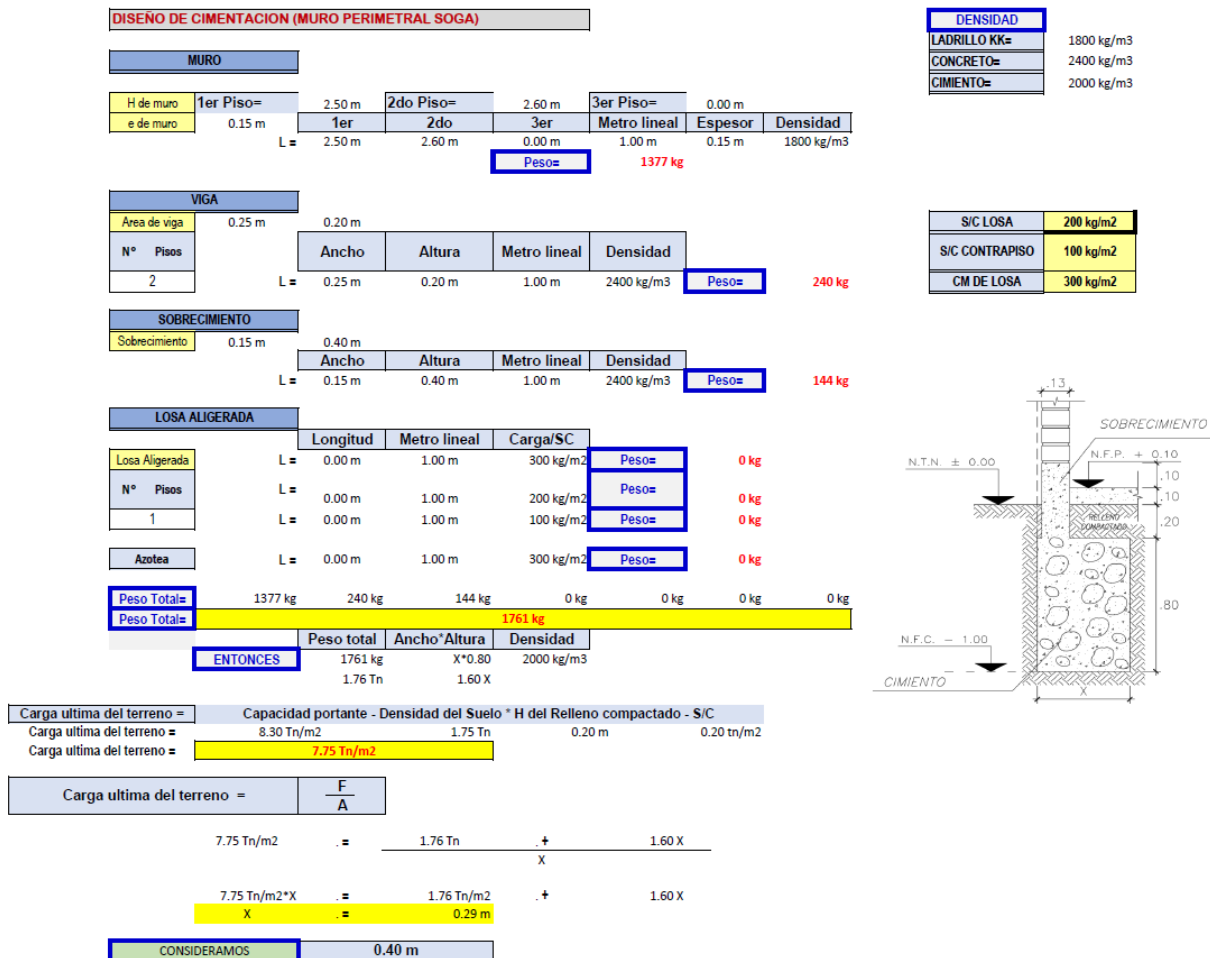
Diseño de Cimentación, para muros perimetrales de sogá (Fuente: Propia), ver anexo N° 8
